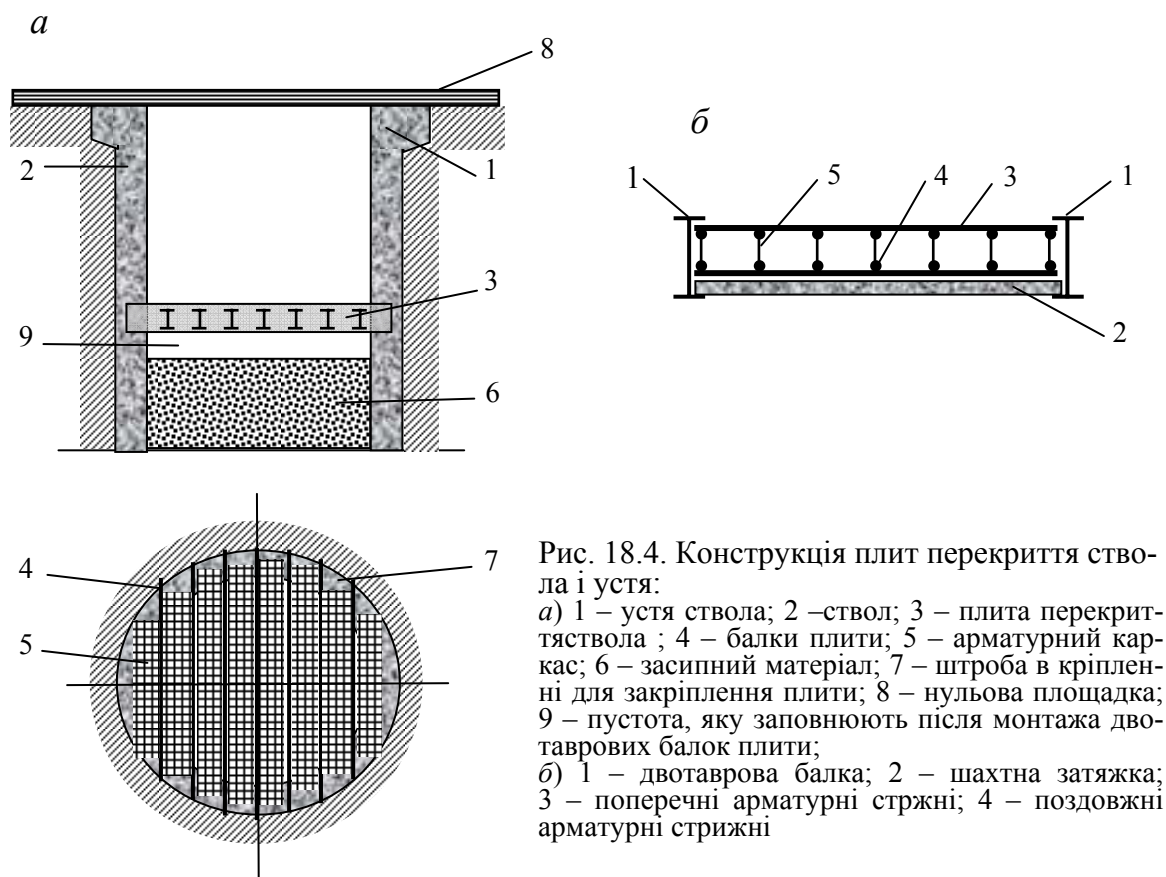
Конструкція плит перекриття ствола і устя:
